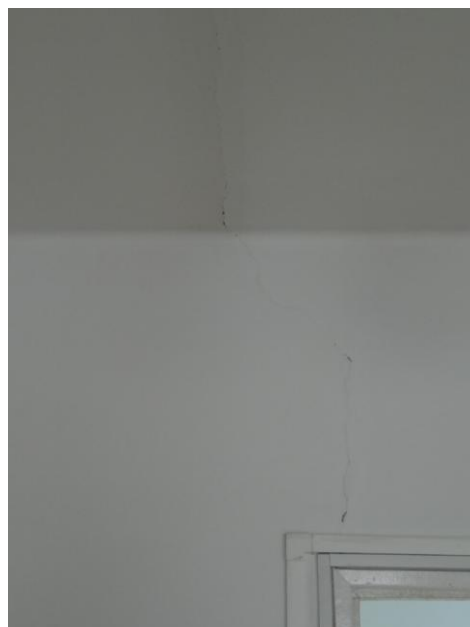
B – I piętro. Zarysowanie ściany zachodniej w korytarzu
